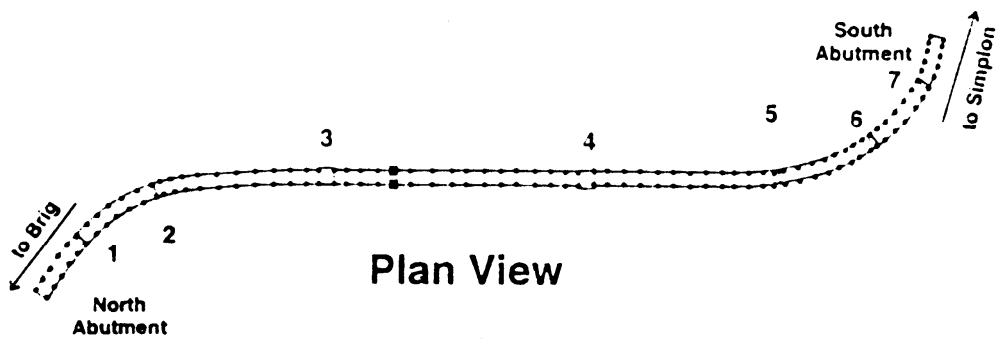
Vue en plan du Ganter Bridge (Suisse)
